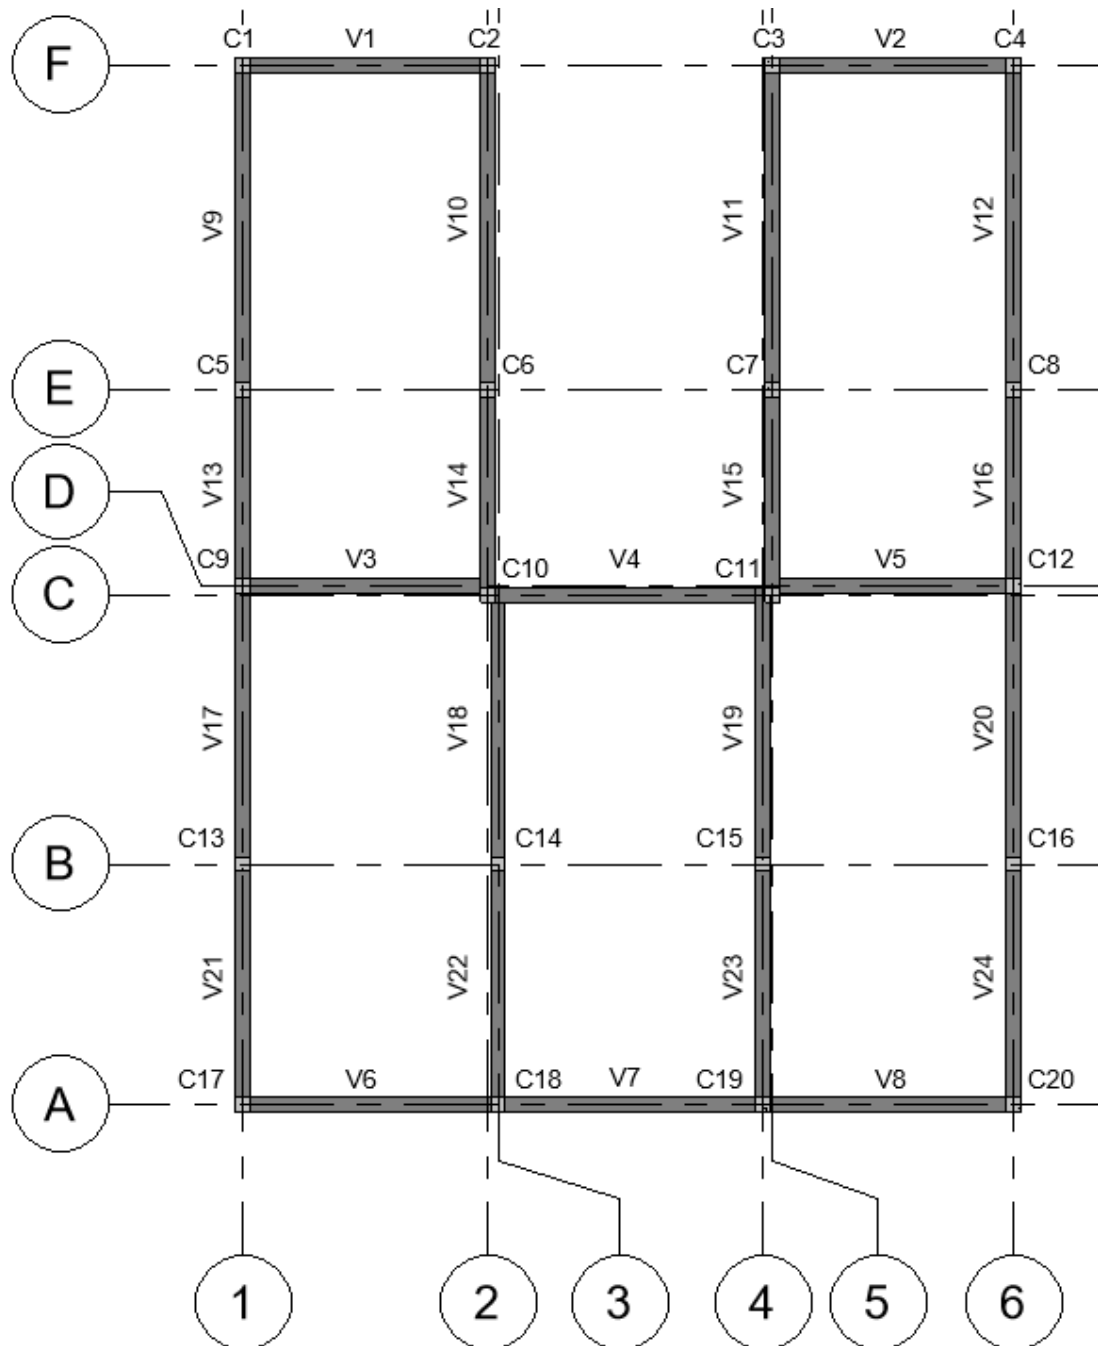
Designación Vigas y Columnas
